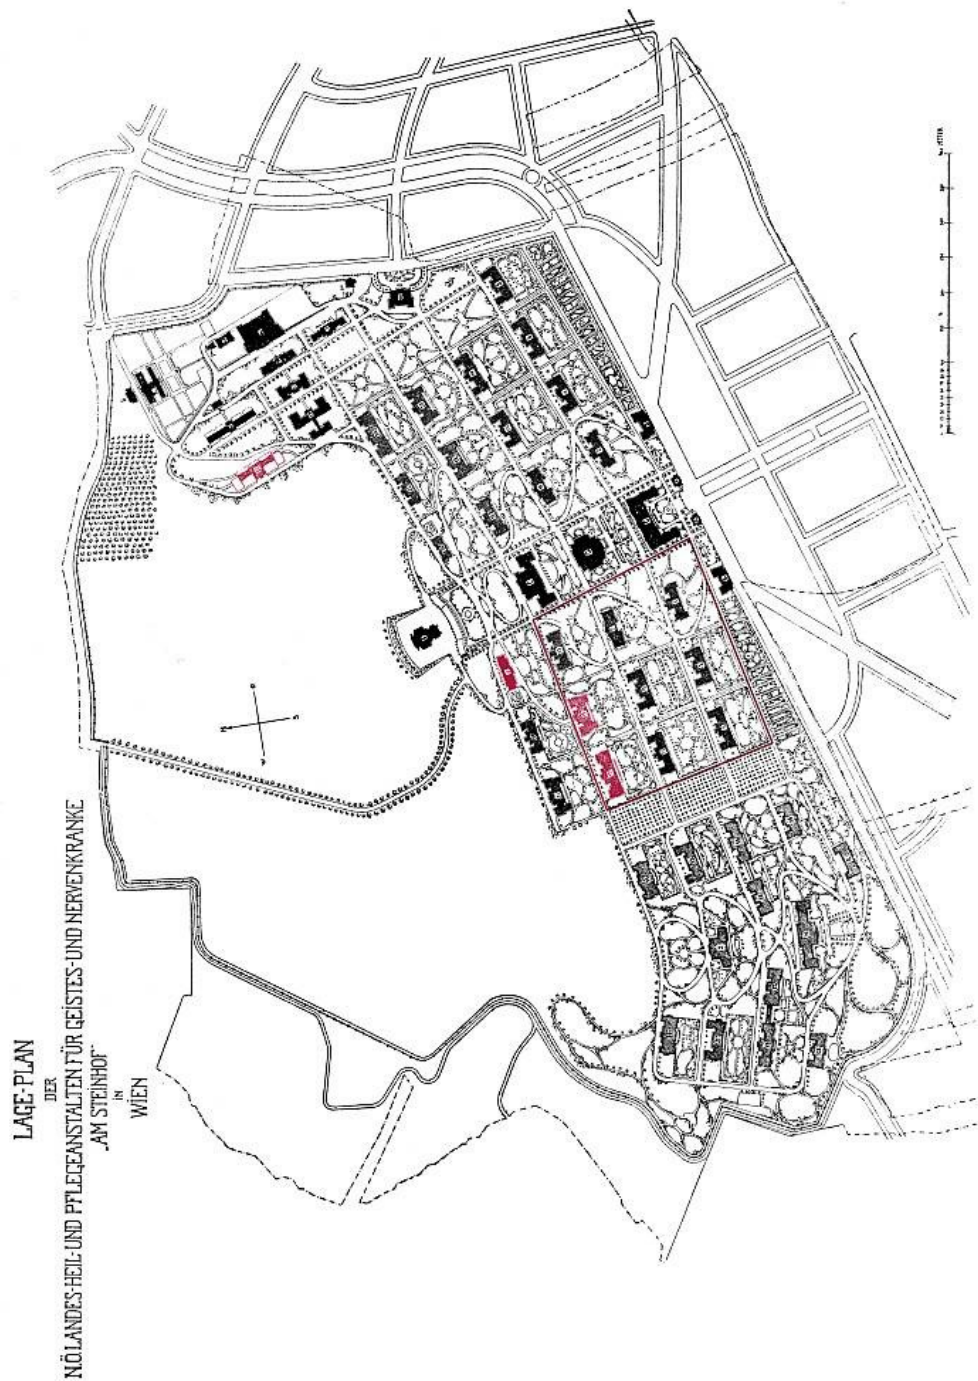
Grundriss der Anstalt Steinhof 1907 ¹¹⁶
